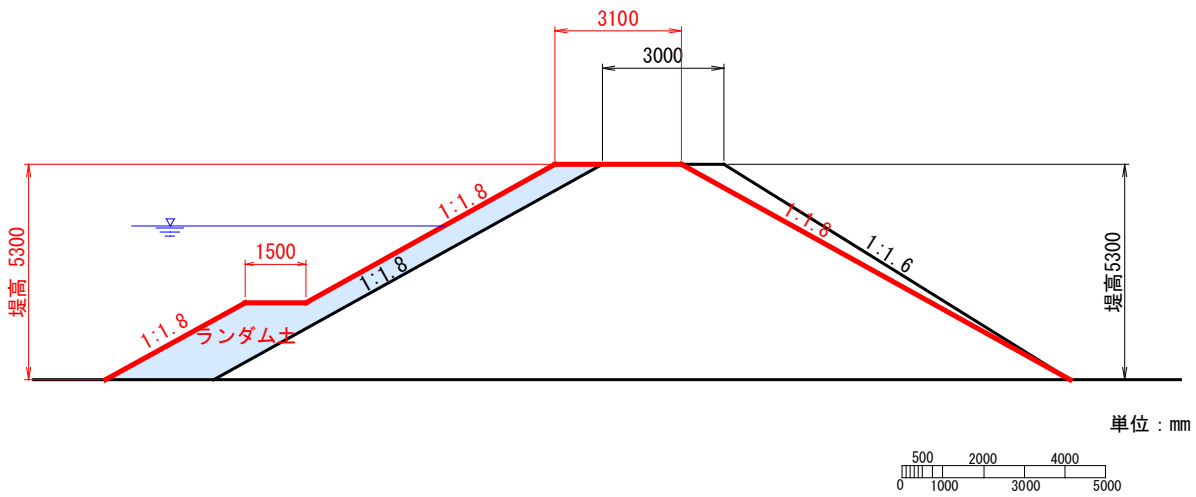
施工コスト算定用計画堤体断面（均一型工法）-1 (H=5.3 m)
